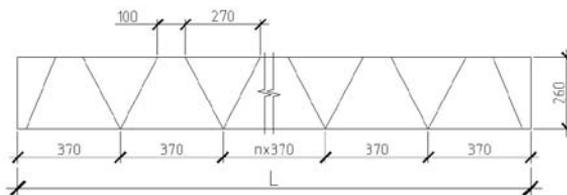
Типовая схема фермы перекрытия (покрытия).
